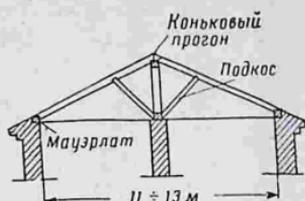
Наслонные стропила для двускатной крыши с продольной линией опор.
